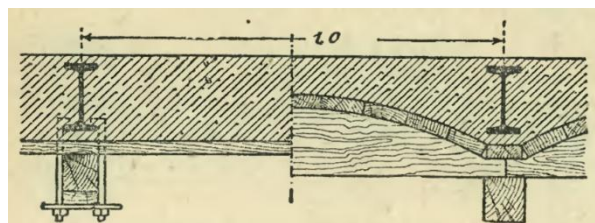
Разрез плиты перекрытия с использованием прокатных балок
